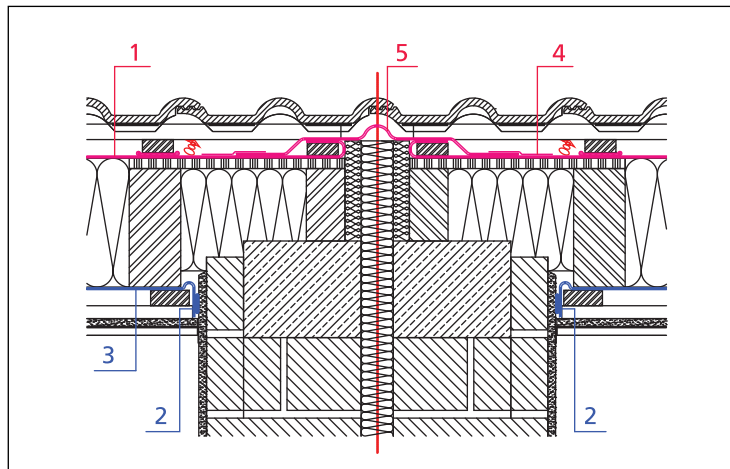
Устройство подкровельной изоляции на пожарной стенке
